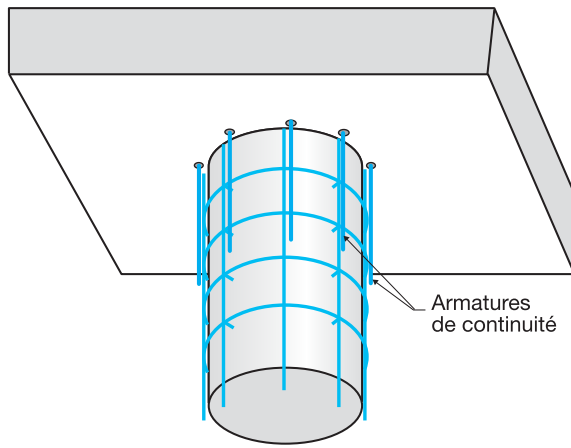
Chemisage en béton armé des poteaux (ferrailage complet)
